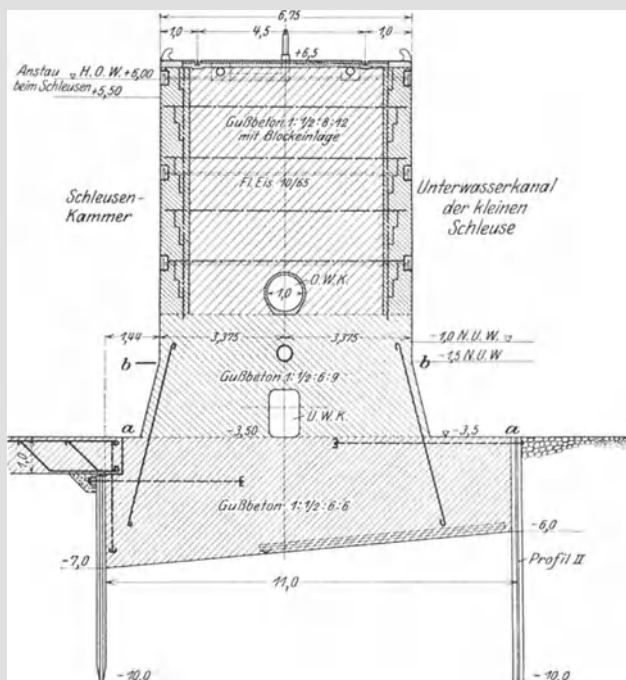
Schleusenmittelmauer in Hemelingen. Querschnitt unterhalb der Bruchstelle. Maßstab 1 : 200.
